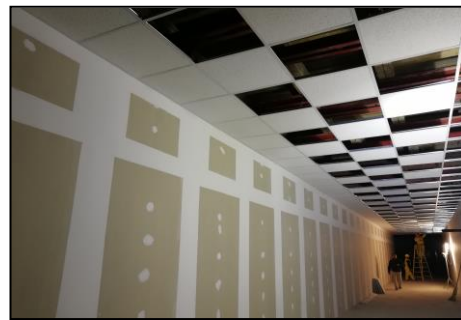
Instalación de planchas estándar para luminarias decorativas led, piso 1.
